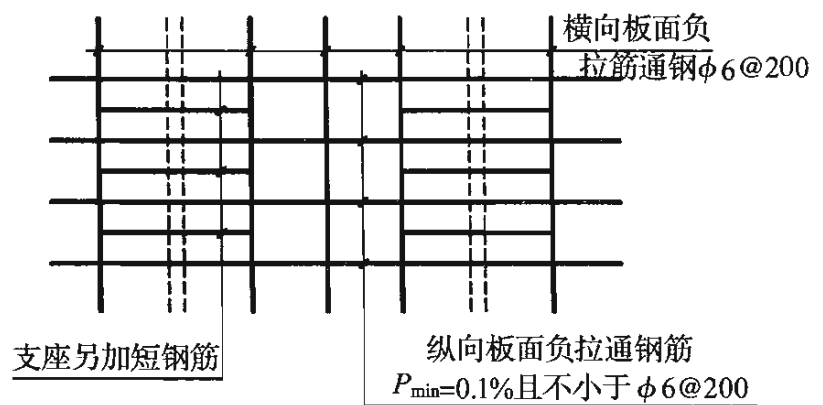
屋面板配筋示意 ($L \geq 30m$)
